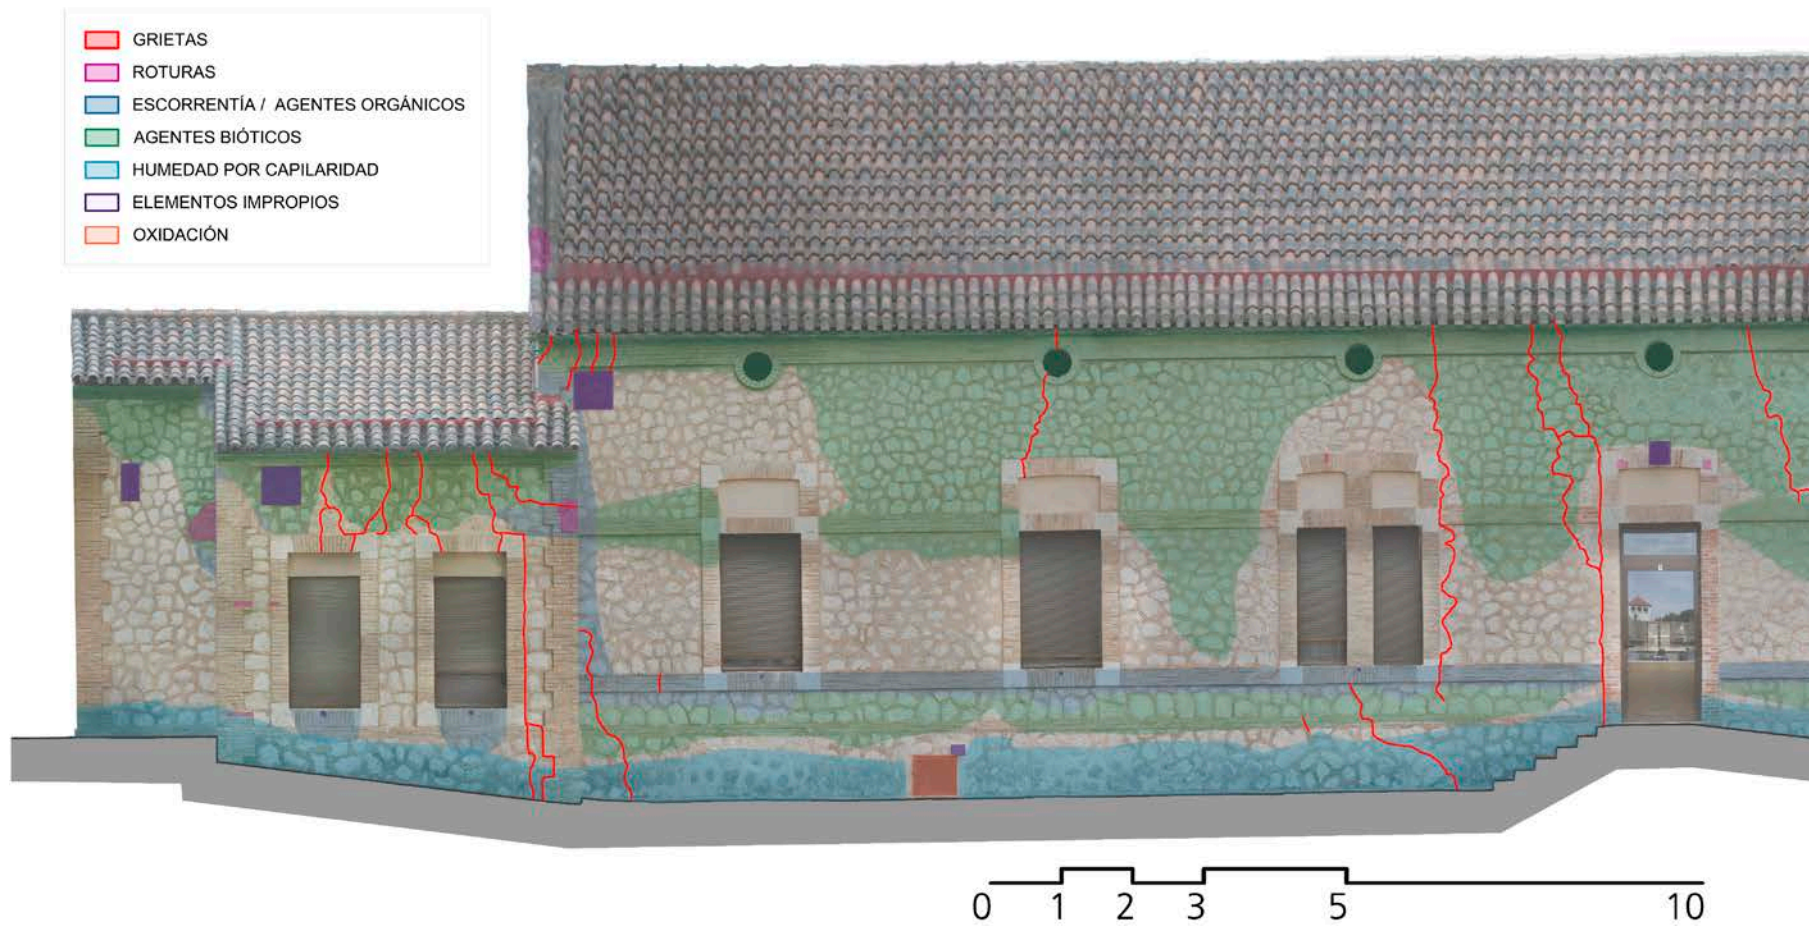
Alzado Lateral. Fachada este. Patología zona meridional.
